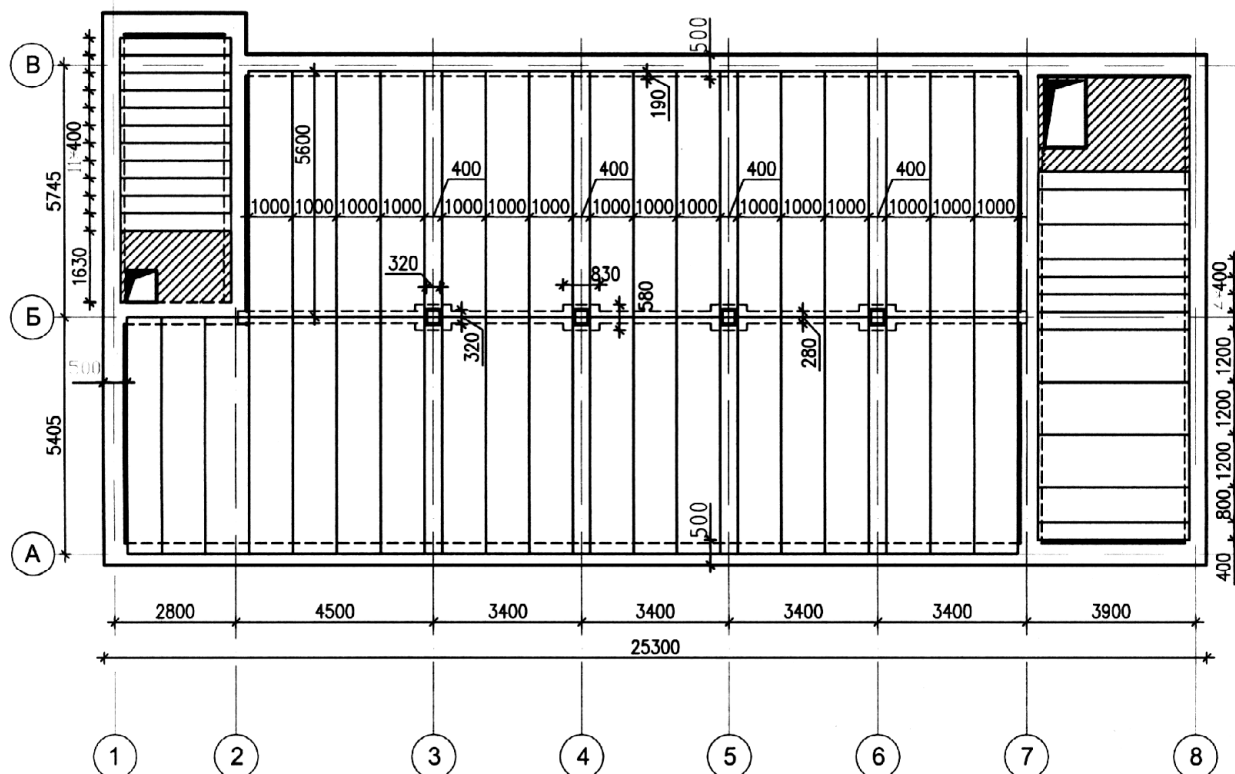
Схема расположения железобетонных плит чердачного перекрытия
